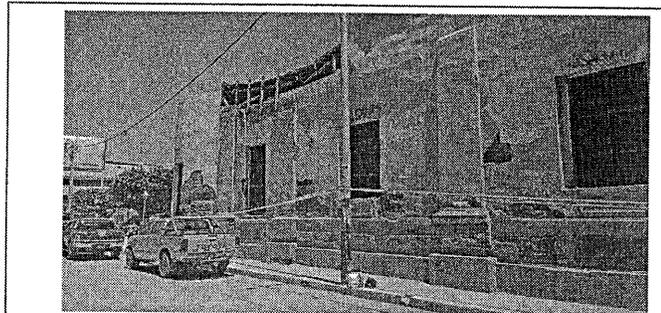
Pared de la Calle Libertad de muros portantes de adobe sobre cimentación y ladrillo y entramado de madera con caña de Guayaquil
